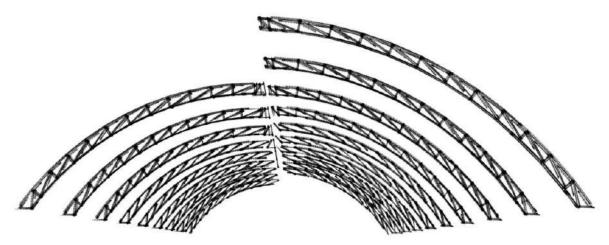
Cerchas metálicas. Fuente: Elaboración propia. (2018).
